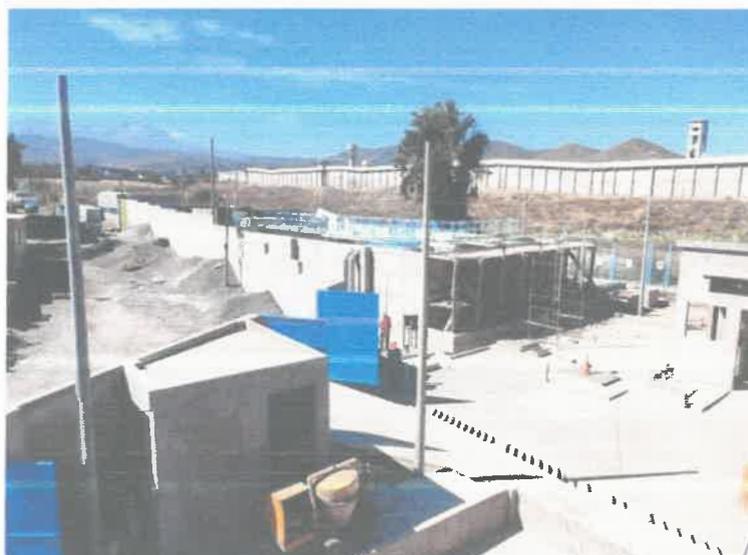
; Vista General de estructuras hidráulicas construidas PTAR de Socabaya.
